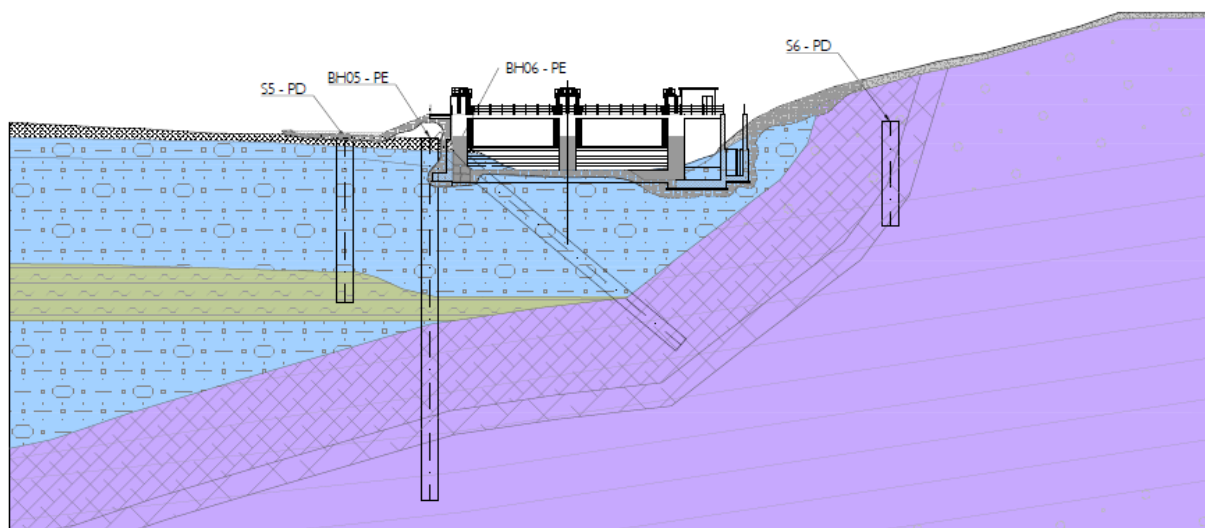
Sezione geologica in asse alla nuova traversa di progetto
